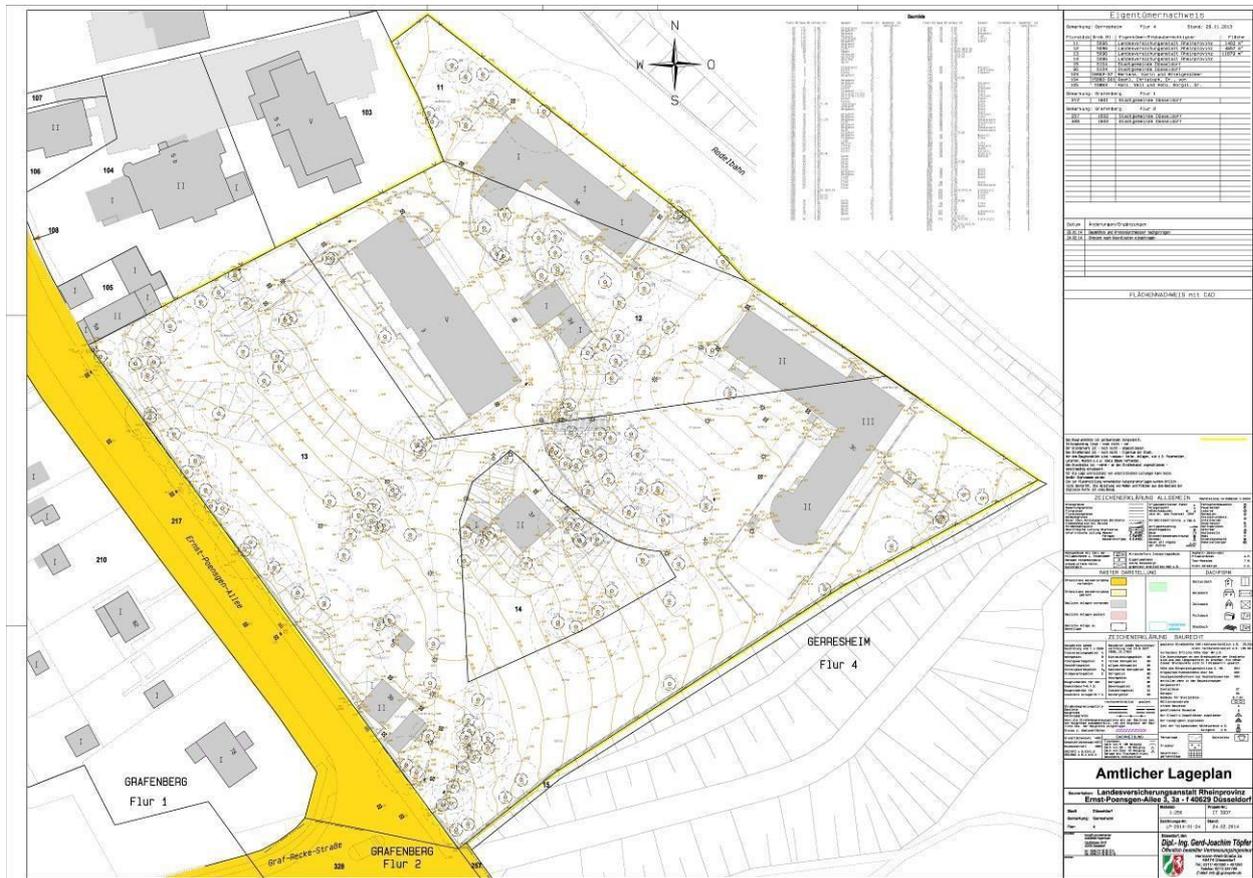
Amtlicher Lageplan mit Bestandsvermessung
